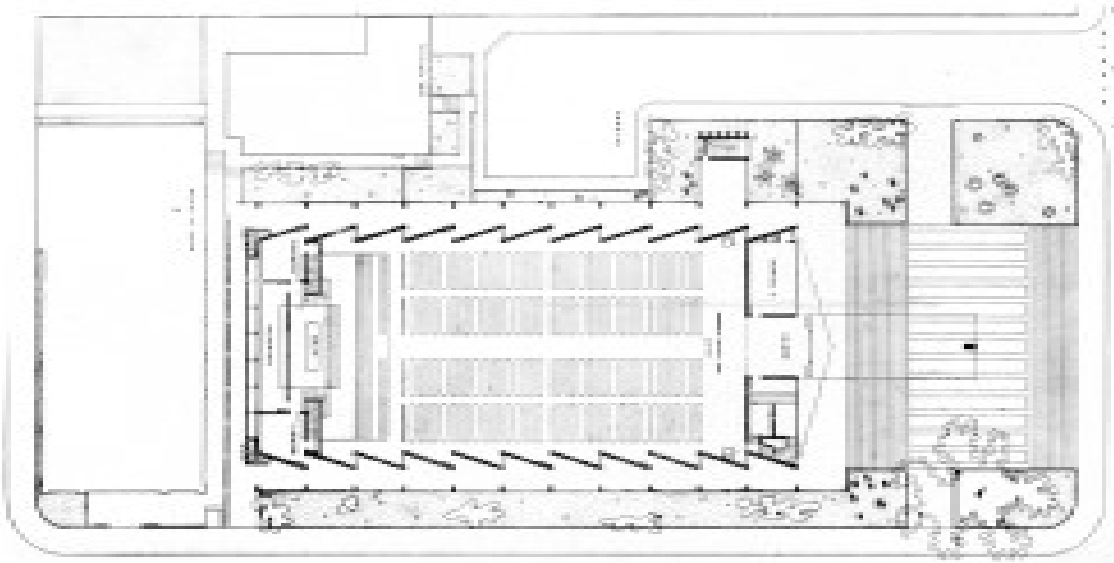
Planta do pavimento térreo: Igreja São Benedito.
